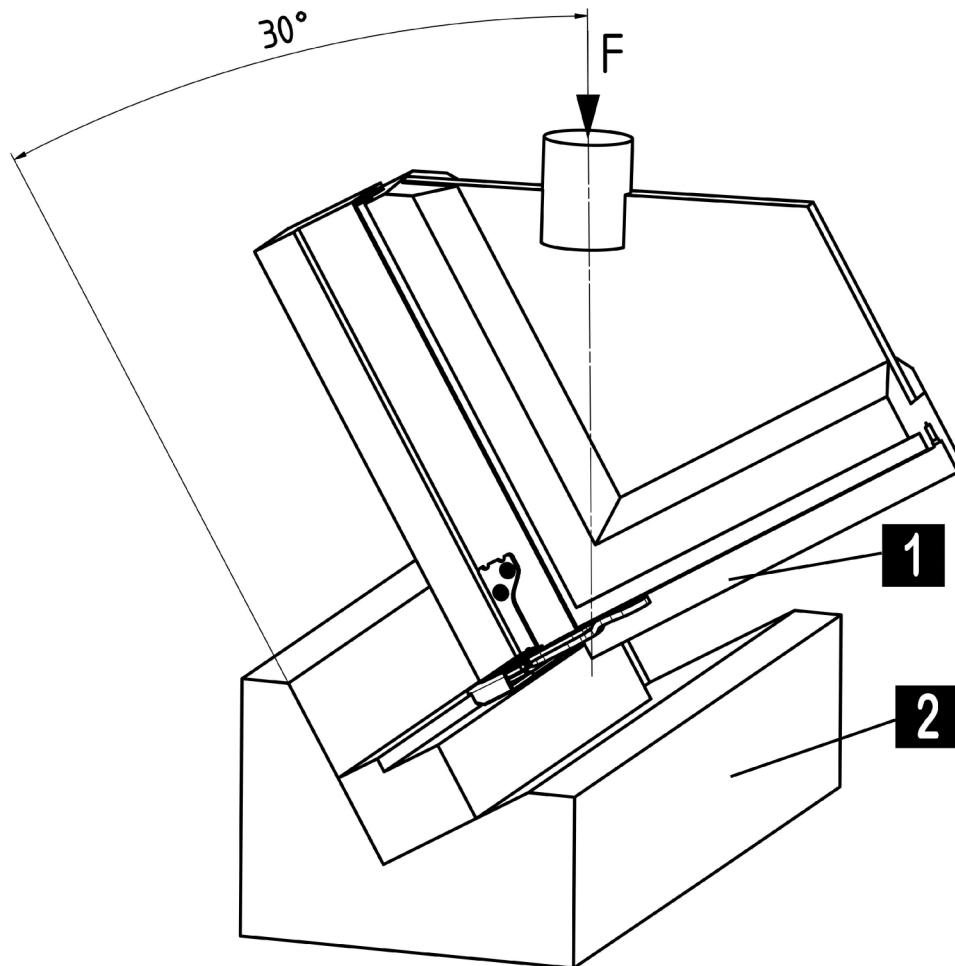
Test schaarlager aan een 300 mm lang profielstuk
